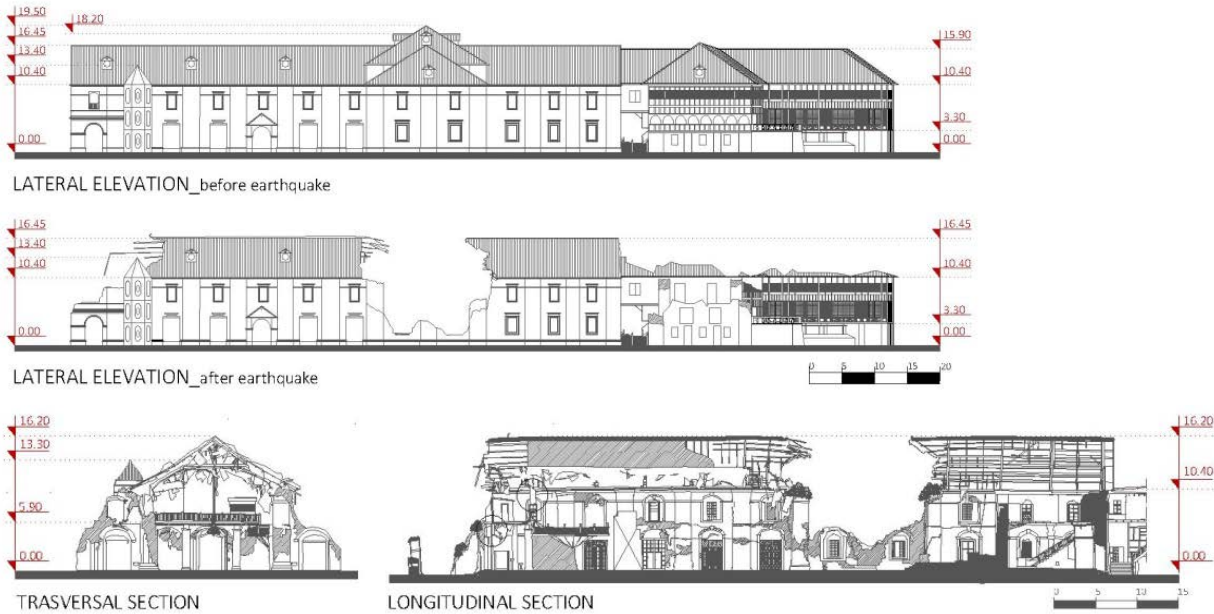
d Loboc: Prospetto laterale prima e dopo il terremoto
